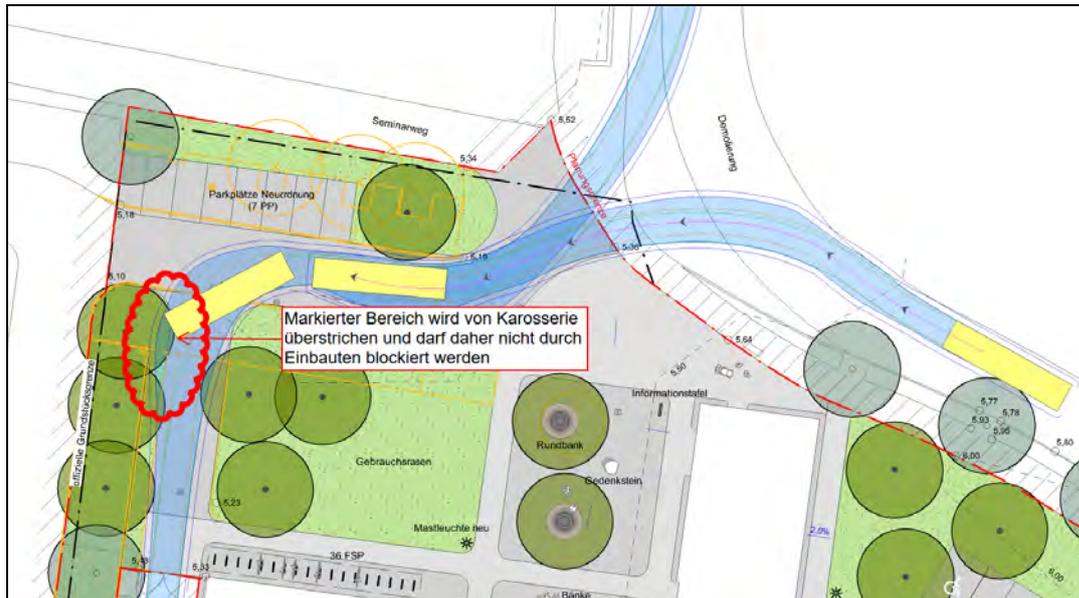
Einfahrt Feuerwehr – Parkierungsanlage West
